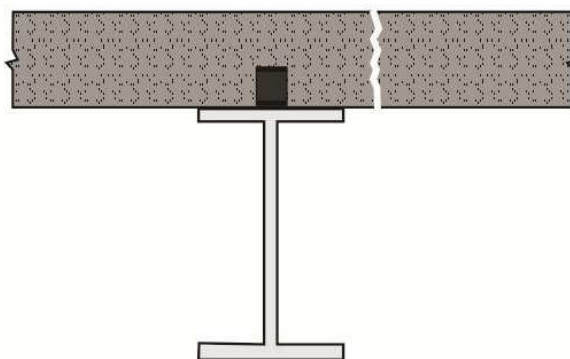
Fluxo cisalhante na laje de concreto.
